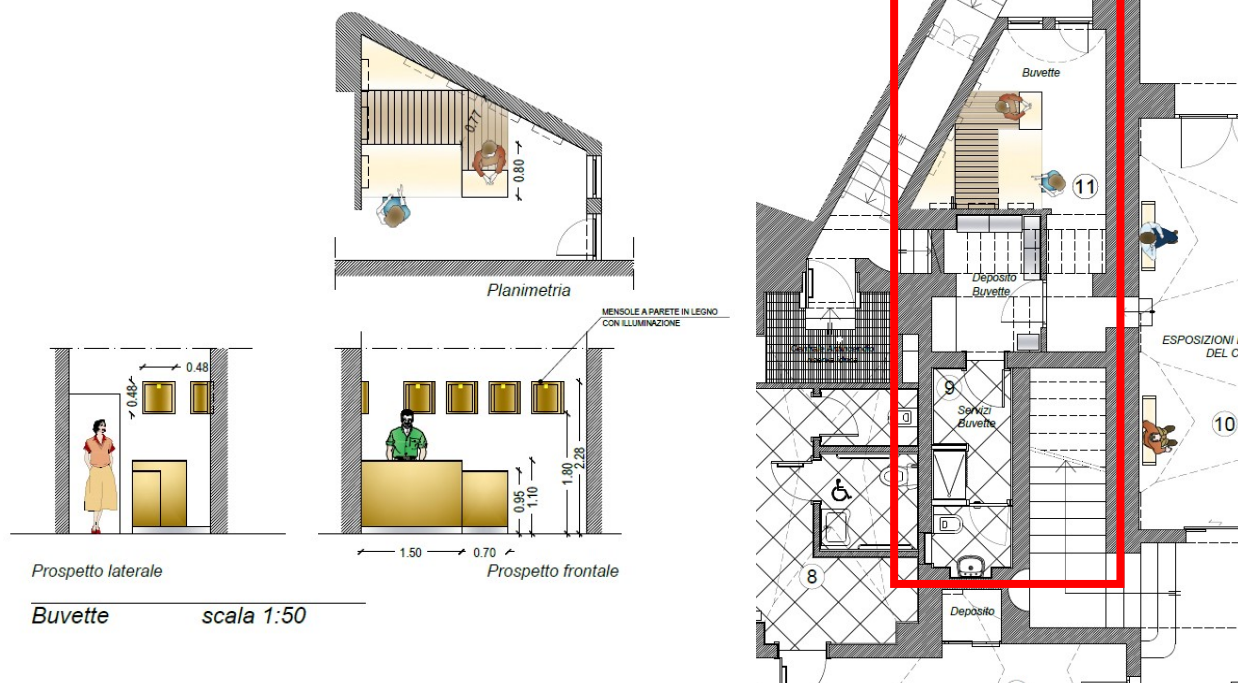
Stralcio della planimetria del piano terra con individuazione della buvette (in rosso) e dettaglio della stessa
